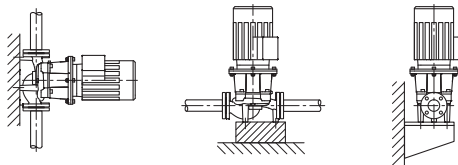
Vista IPL - Instalação sobre fundações (≤ 7,5 kW)
